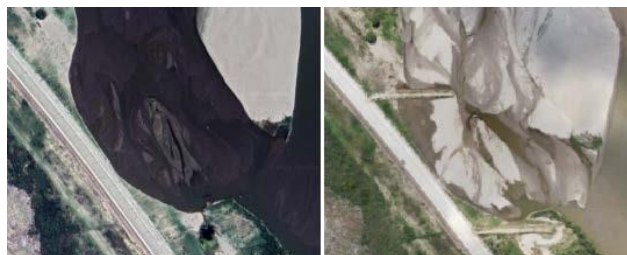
Zona de emplazamiento de espigones; escenario previo a la construcción (izquierda); escenario actual (derecha).
